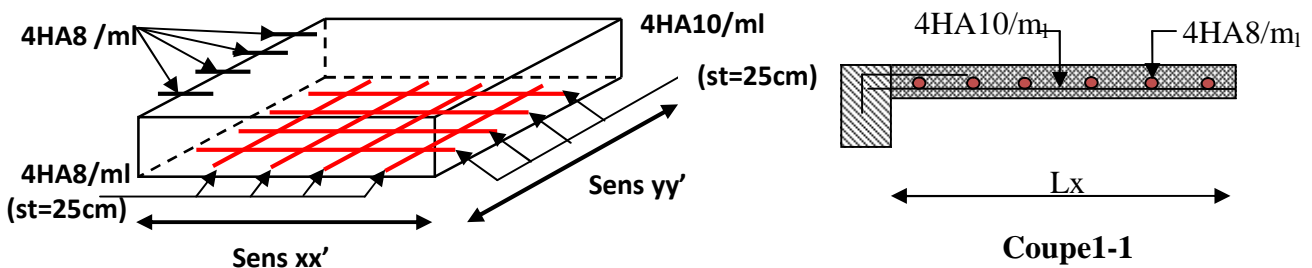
Schéma de ferrailage de la dalle sur un seul
